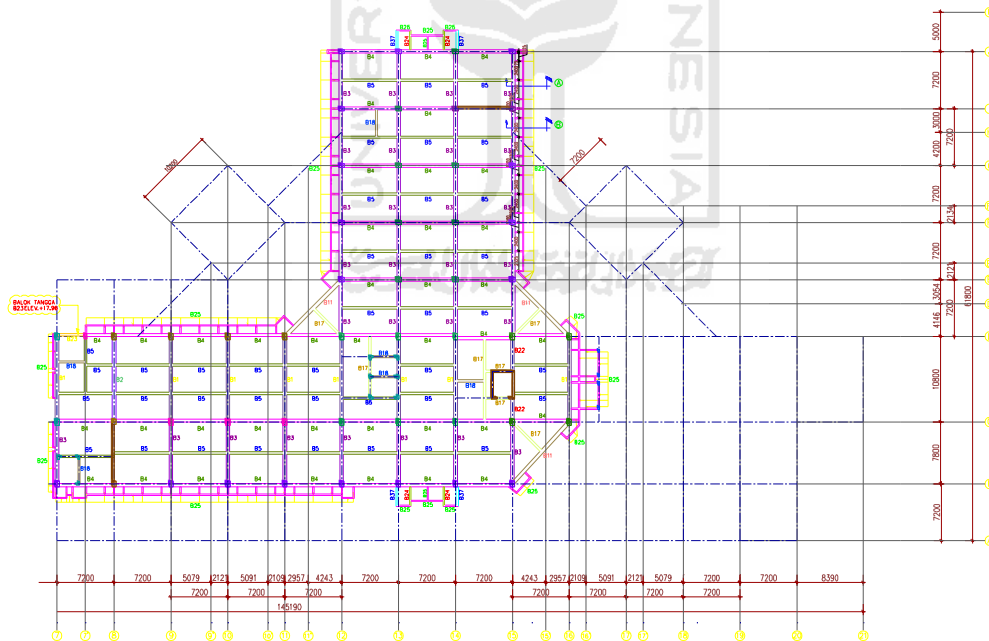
3 Denah Balok Gedung RSA UII Lantai 3
